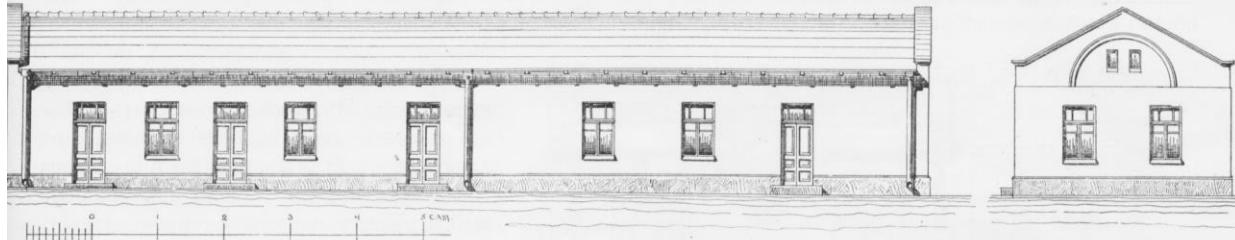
Домъ для рабочихъ съ прачечной и баней (по проекту). Слѣва—дворовый фасадъ, справа — фасадъ къ лиману.
